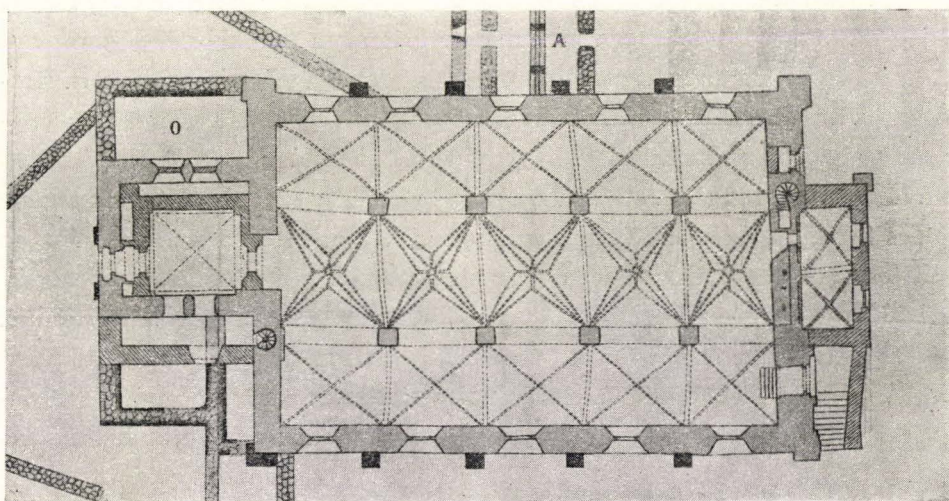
Plan av Nådendals kyrka, enligt Hausen.
